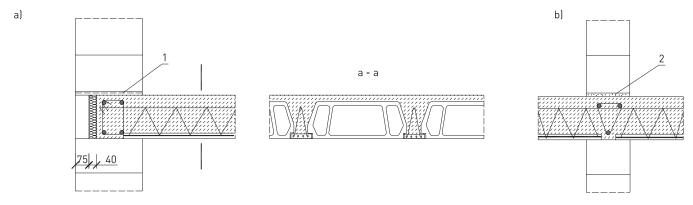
Опирание монолитных и монолитно-сборных перекрытий:
